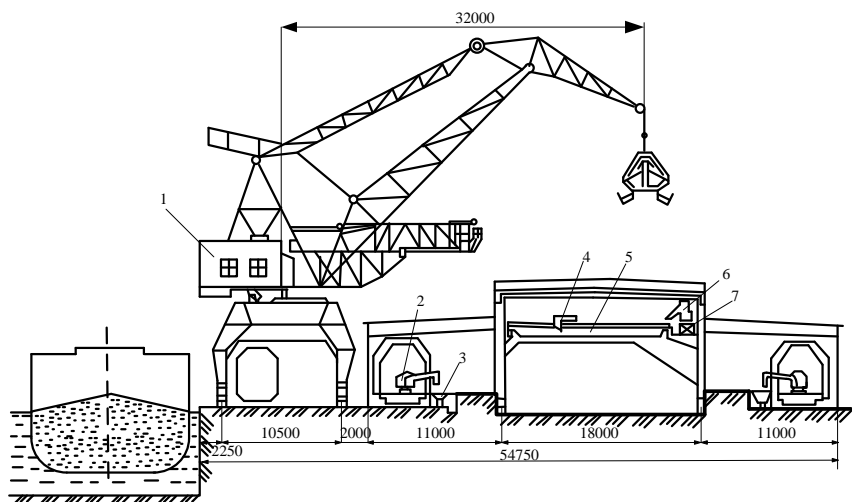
Схема комплекса для погрузки навалочных грузов закрытого хранения в суда:
